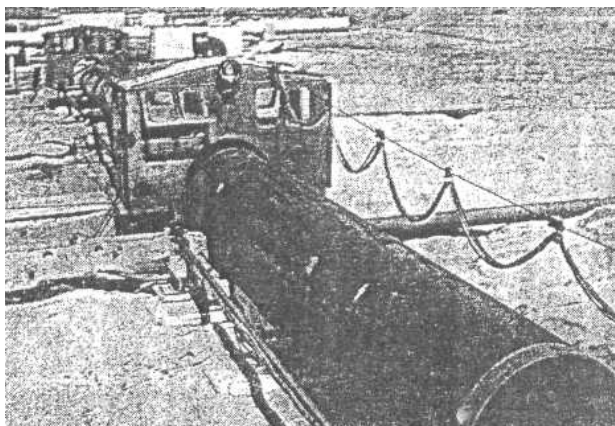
Сварка труб большого диаметра на трубосварочной базе
